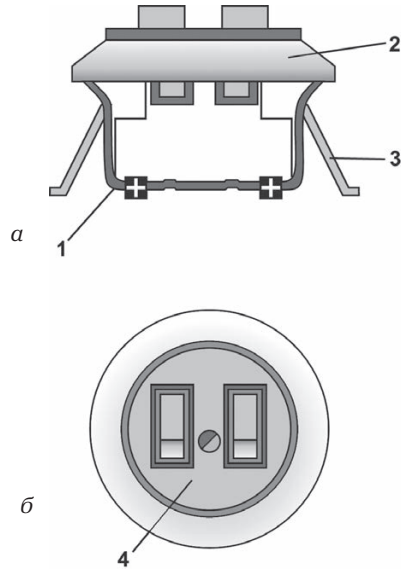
Установка закрытого выключателя: а — вид сбоку в разрезе; б — вид сверху после установки; 1 — стальная или пластмассовая коробка; 2 — корпус; 3 — распорные лапки; 4 — винт
